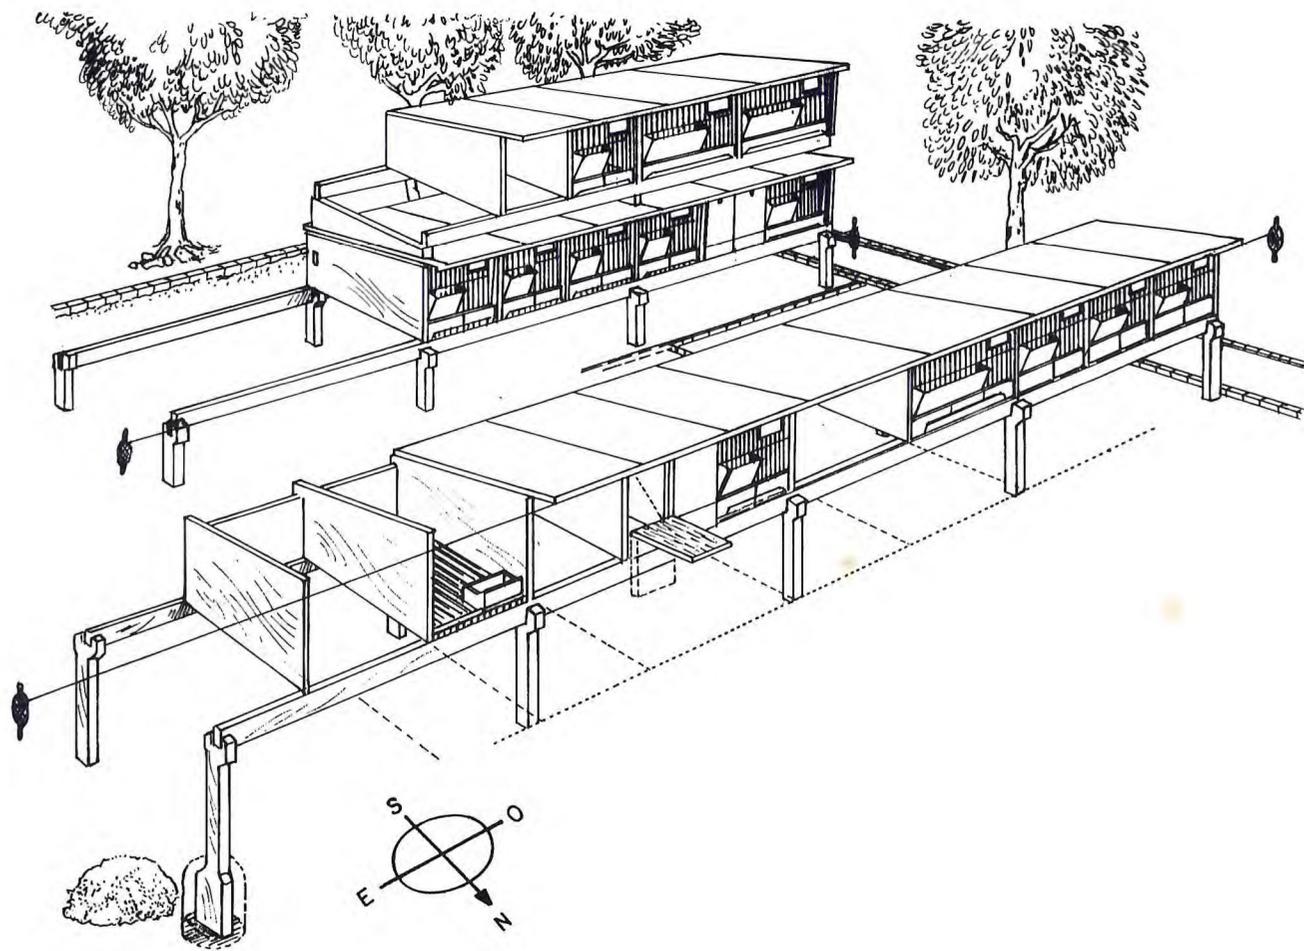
Conjunto de gaiolas de concreto pré-moldado.
